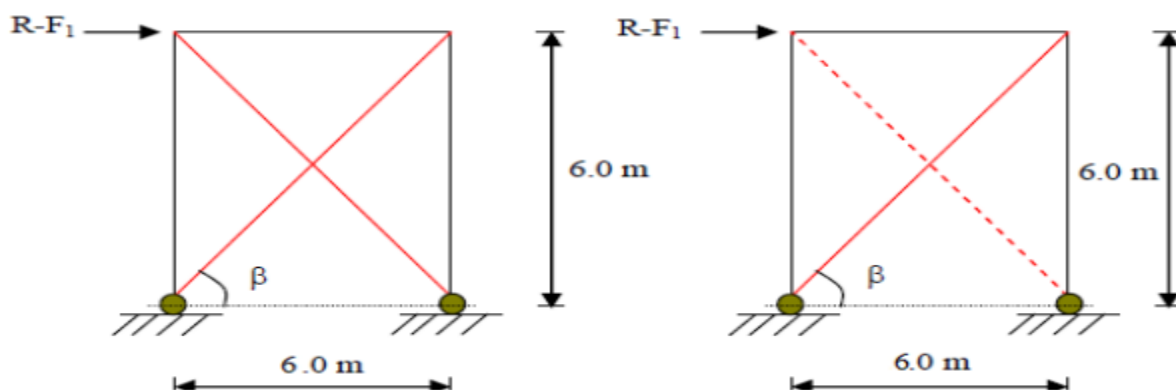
Schéma statique du Palée de stabilité en long pan
